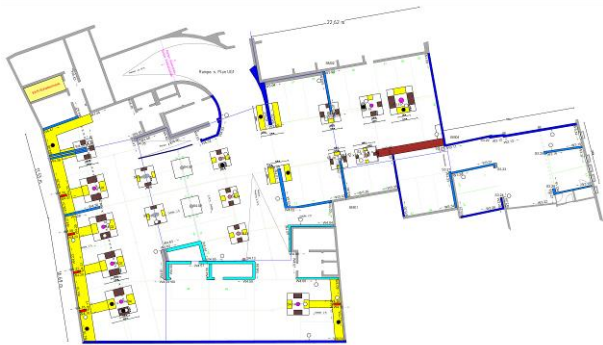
Grundriss UG2 mit KKS-Schutzzonen
